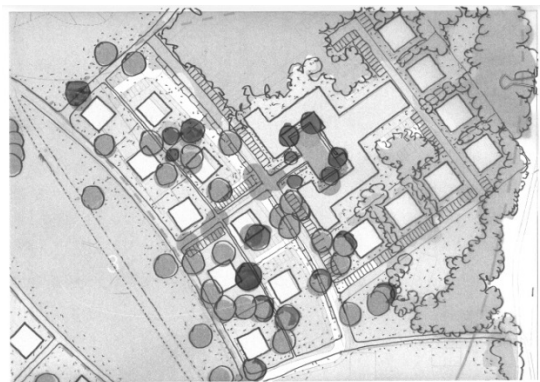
Vertiefungsbereich 3/ Hindenburghaus
